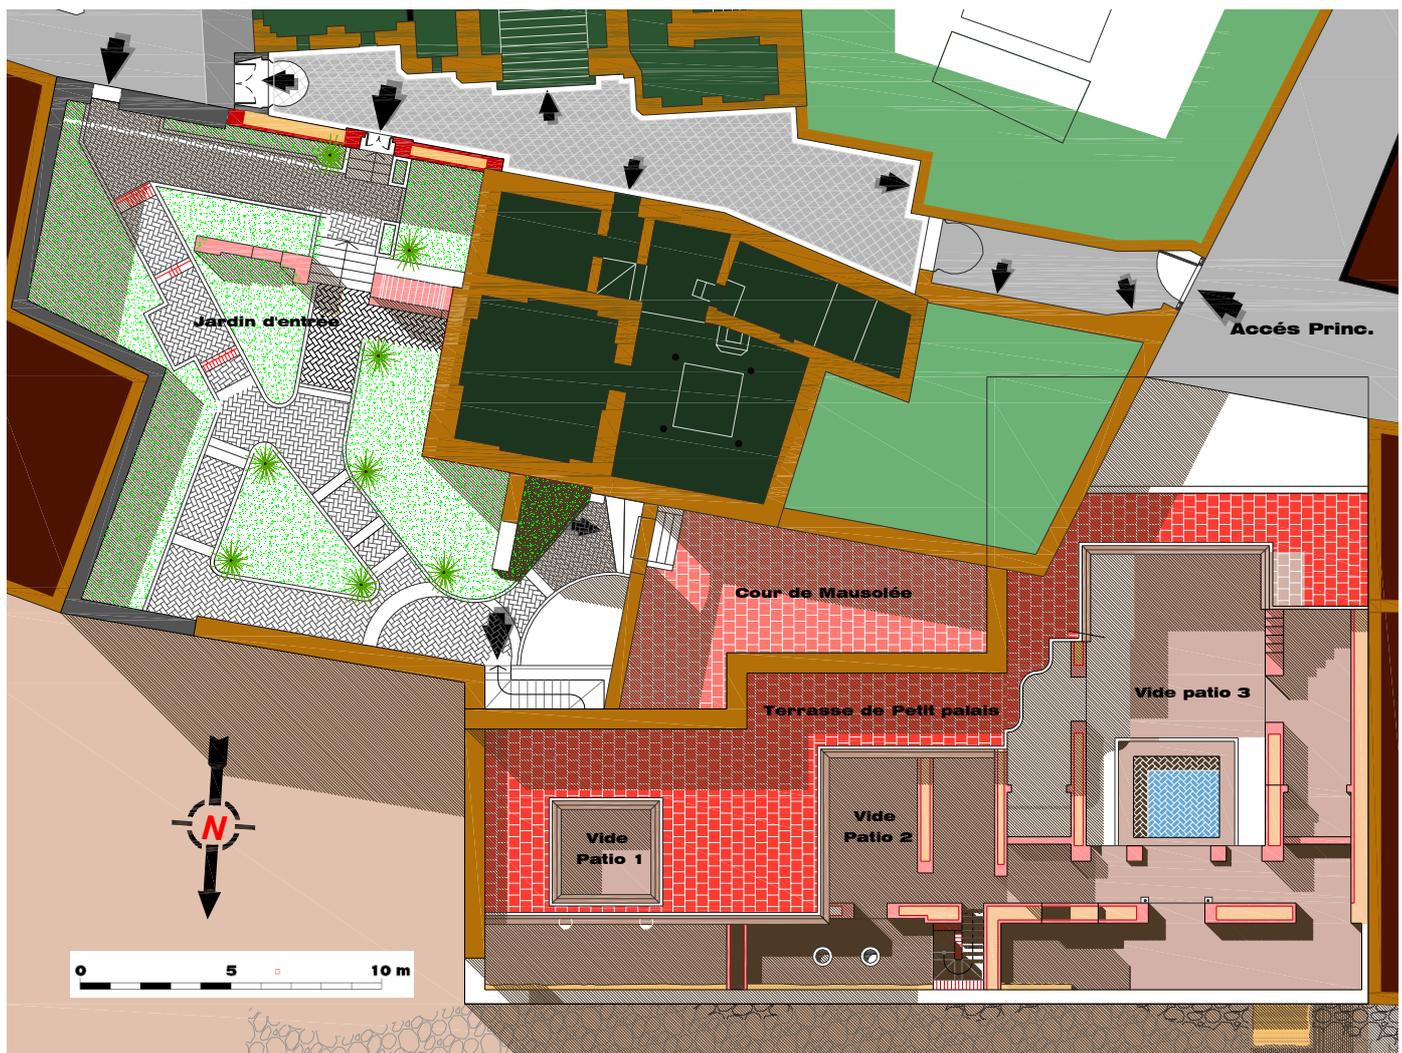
Plan de l'état des lieux, Terrasse Existante.
